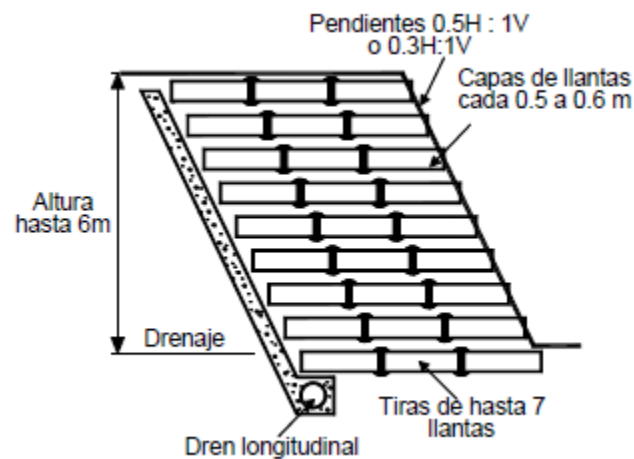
Esquema de muro con llantas planteado por Hausmann (Suarez Diaz, 2013).
